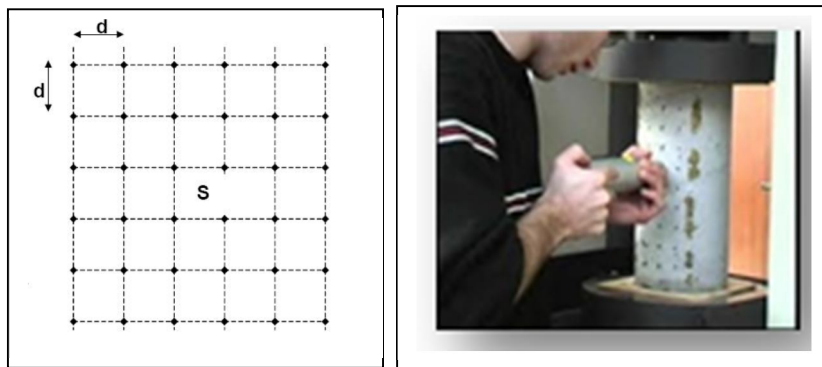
Grille de mesure sur ouvrage et l'éprouvette
